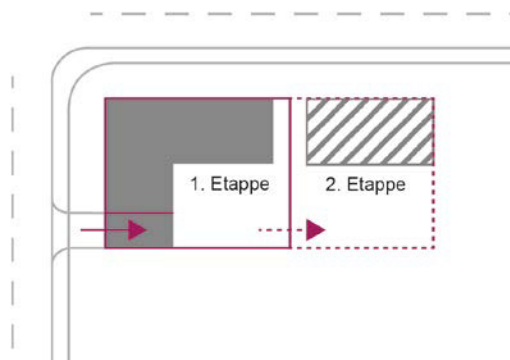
Anordnung von unterirdischen Sammelgaragen mit Erweiterungsoption. Das Rampenbauwerk ist in das Gebäude integriert.
